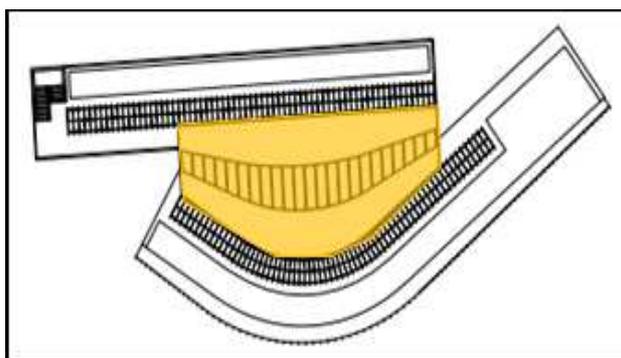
Plan de toiture Source : <http://www.archdaily.com> Traité par auteur
